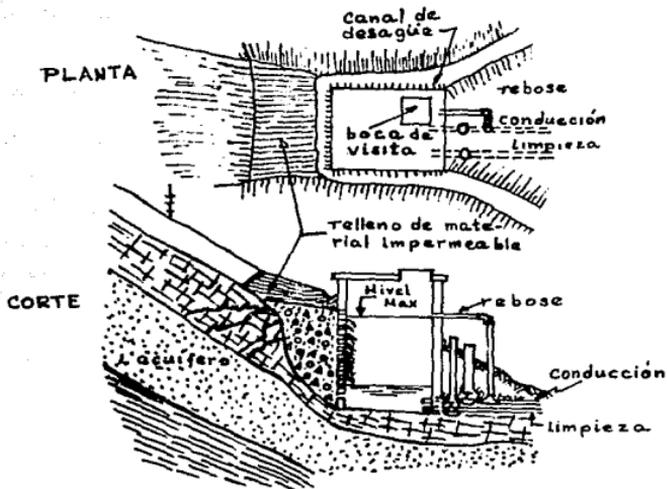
Dibujo Esquemático de obras de captación de manantiales con afloramiento horizontal.
